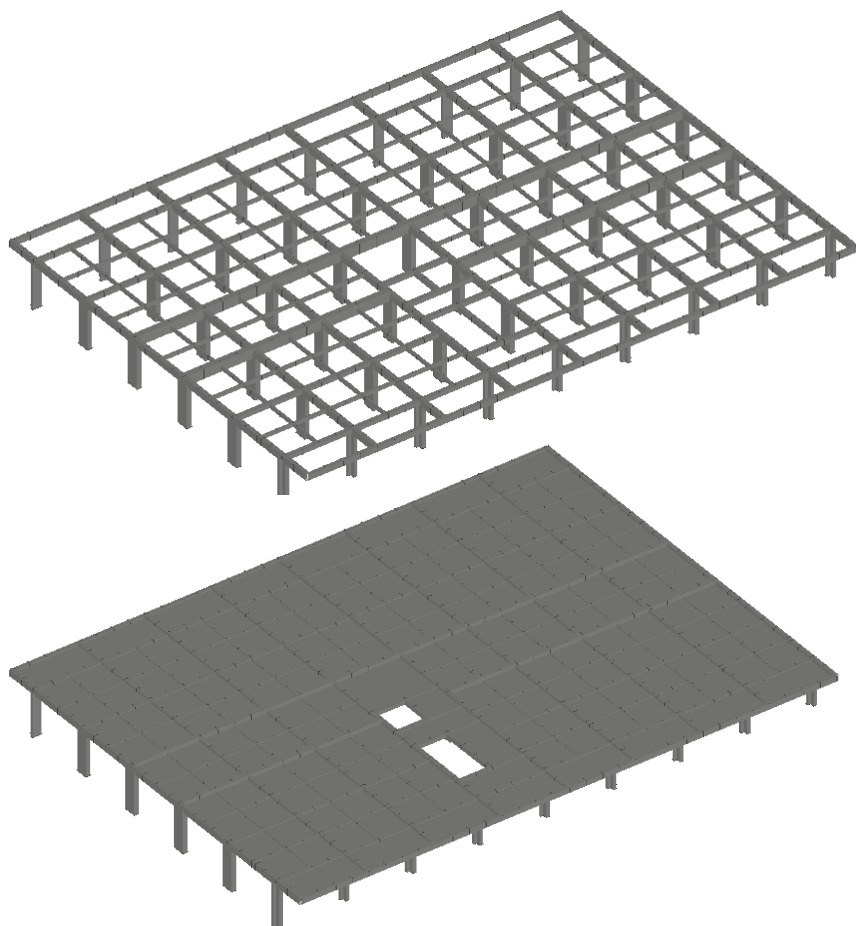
Modelo "sólido" de la estructura principal (sup.) y la estructura de la planta tipo cortafuegos (inf.)
